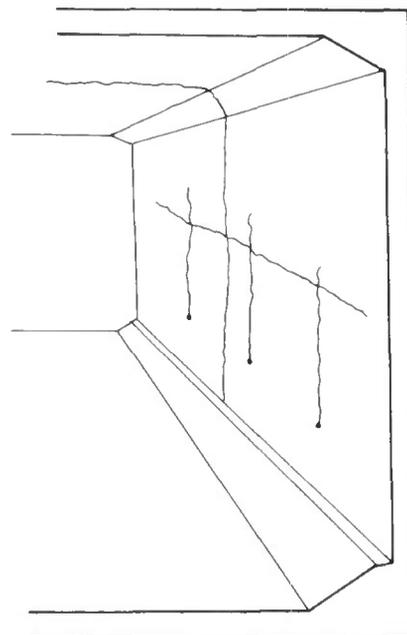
Fissuration pouvant affecter les piédroits et traverses des portiques et cadres.
